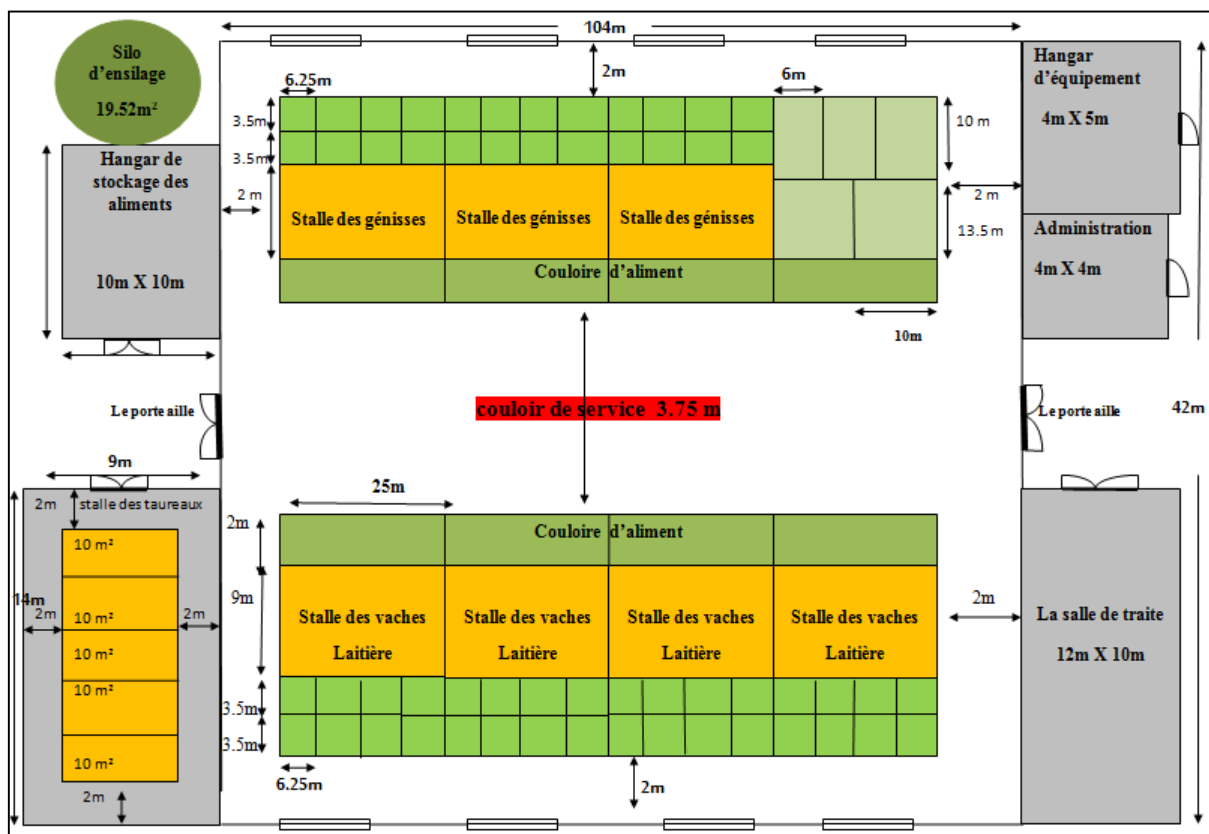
Plan de bâtiment en stabulation libre à 100% paillée de 200 vaches laitières
